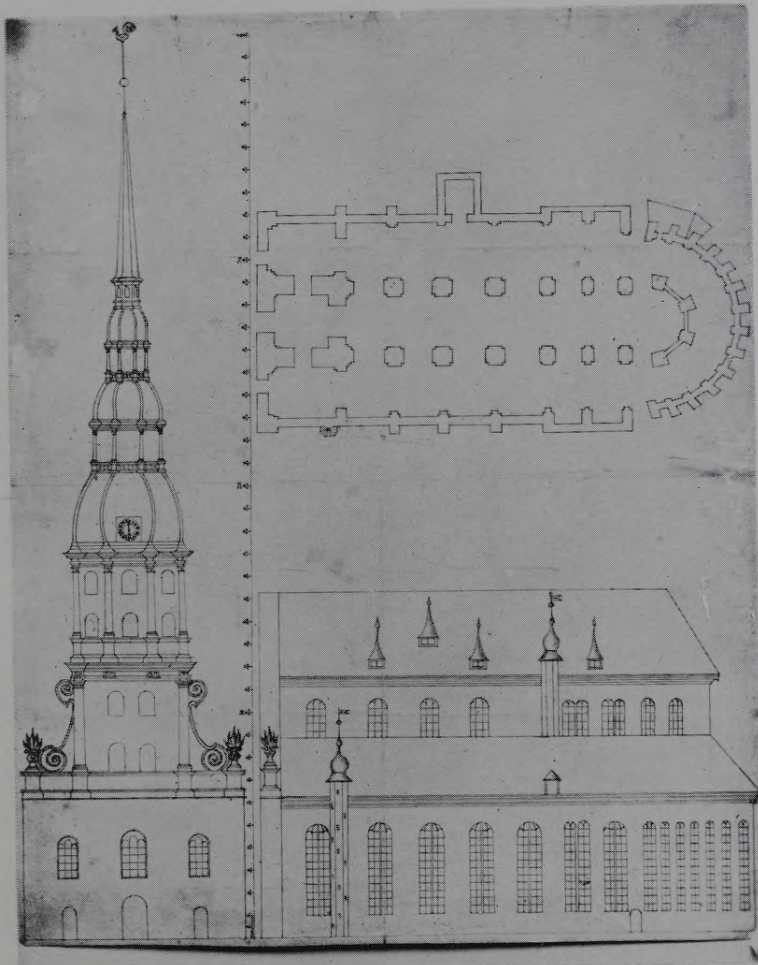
Grundriss, West- und Südansicht der Petri-Kirche zu Riga.
